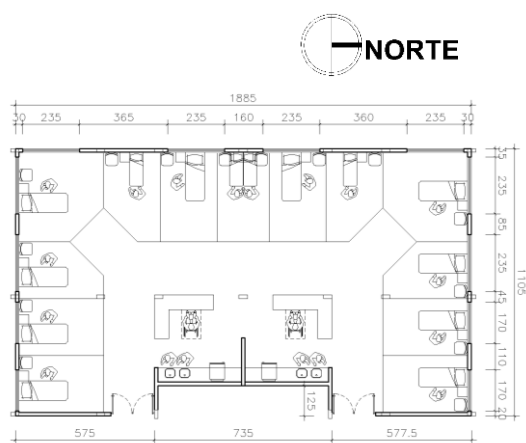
Planta baixa do caso base (BRASIL, 2016 adaptado pelos autores).
